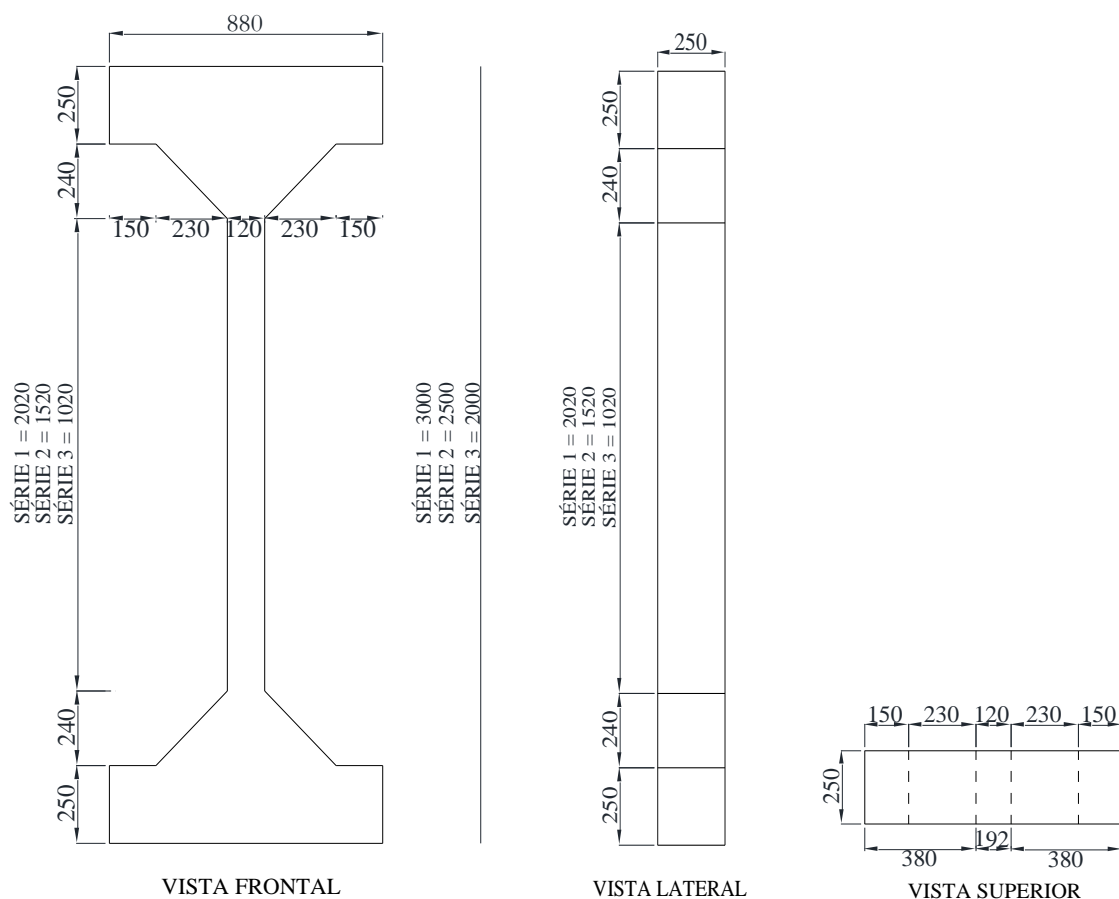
Dimensões em mm dos pilares ensaiados (MELO, 2009)
